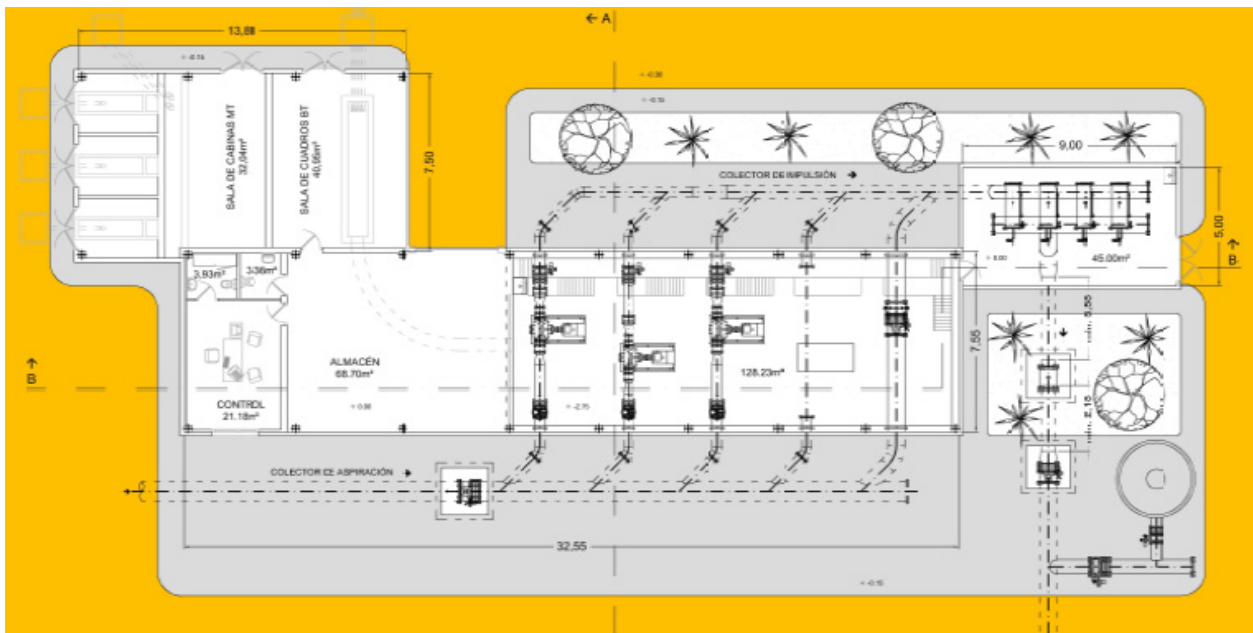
Planta del edificio para cabezal de sector con impulsión propuesta
